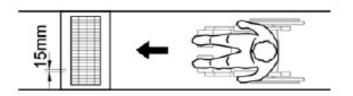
Grelhas instaladas transversalmente às rotas acessíveis
